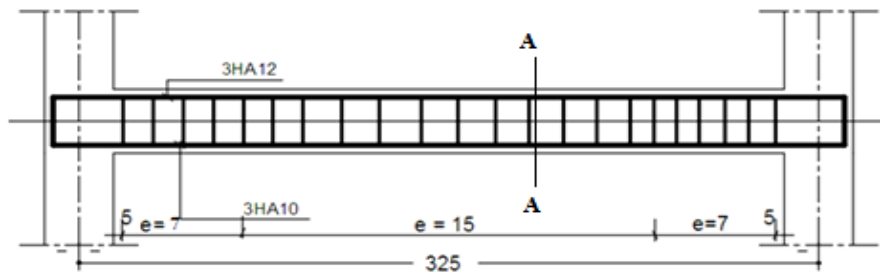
Plan de ferrailage de la poutre de chaînage.
